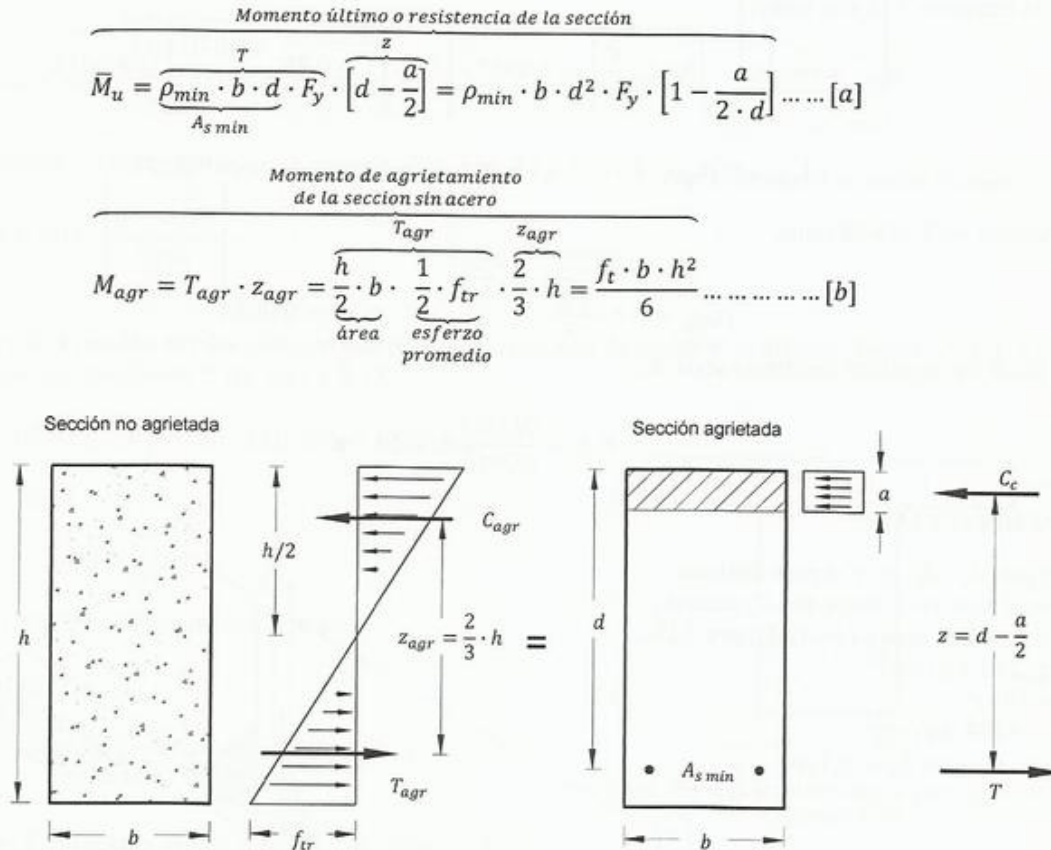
Fuerzas en el concreto y acero inmediatamente antes y después del agrietamiento
